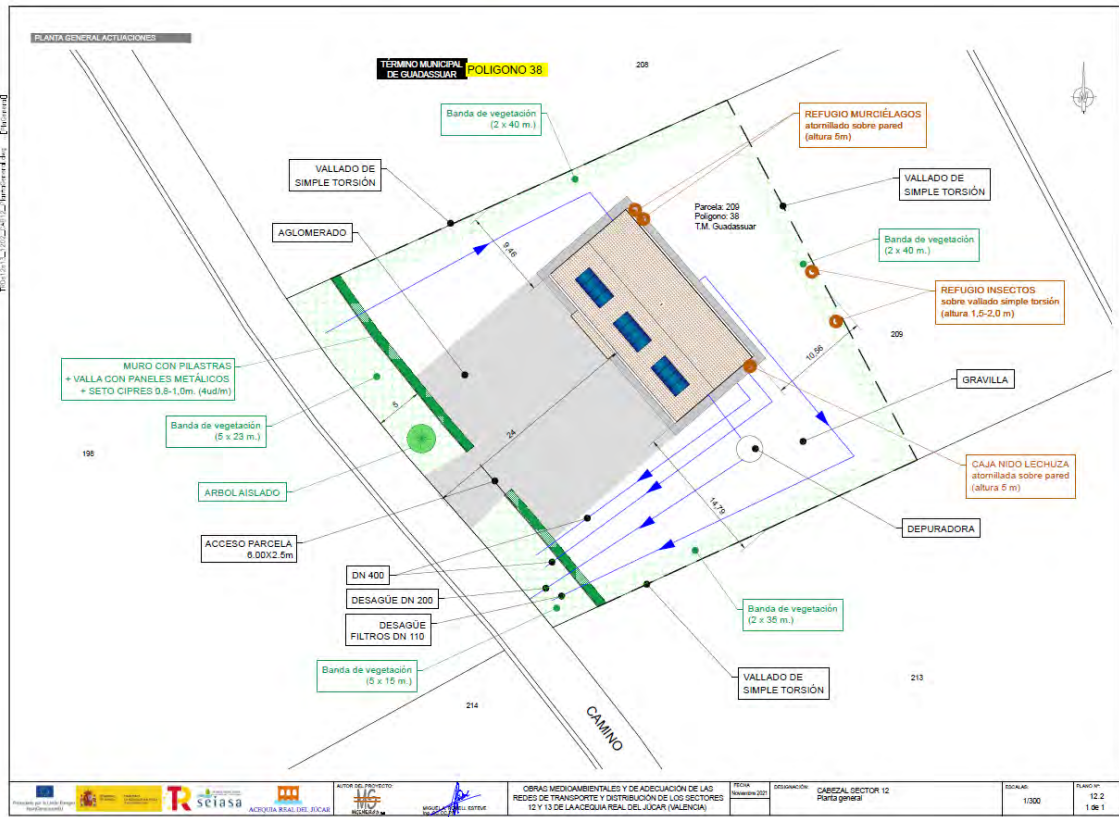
Plano nº 12.2: Cabezal sector 12. Planta general.
